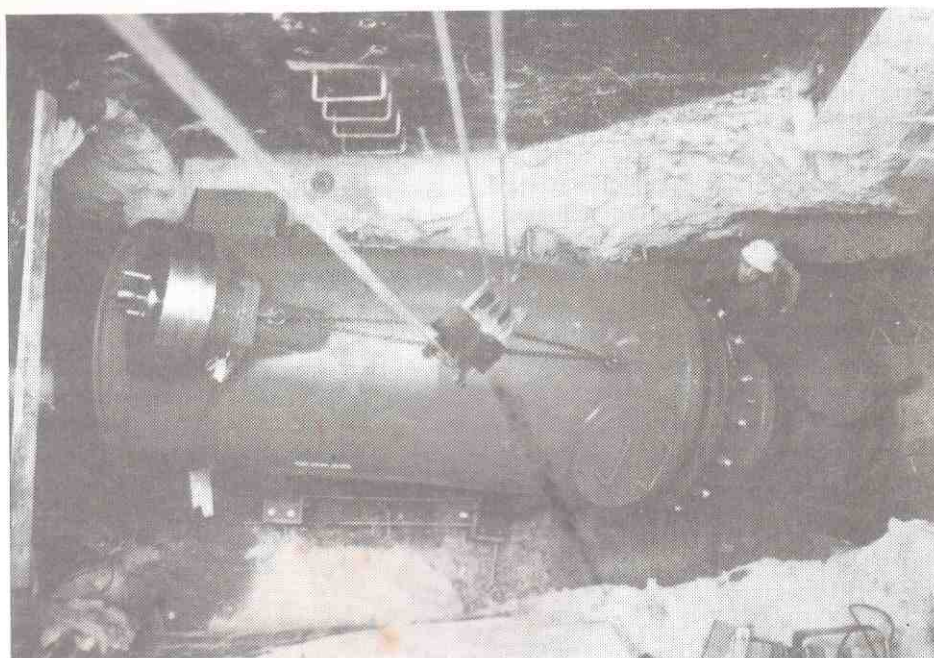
La tubería empleada es del tipo Kaplan de doble regulación.
